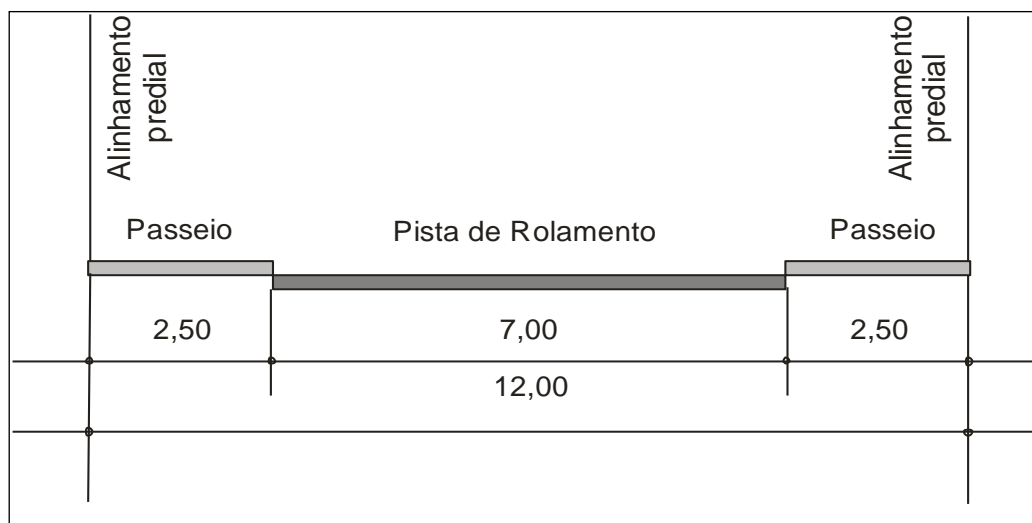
Perfil para rua Dra. Alda Melo e na Estrada da Boa Sorte
